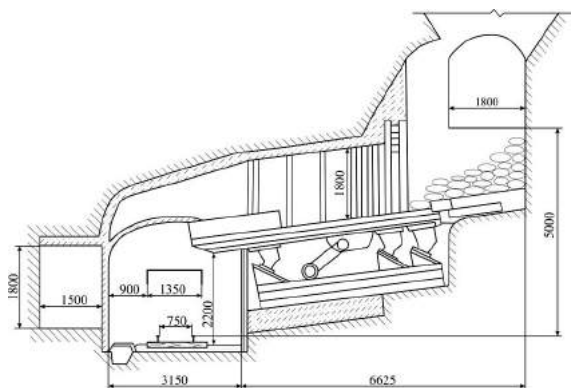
Схематический вид вибропитателя для выпуска и доставки руды ВВДР-5ПС
